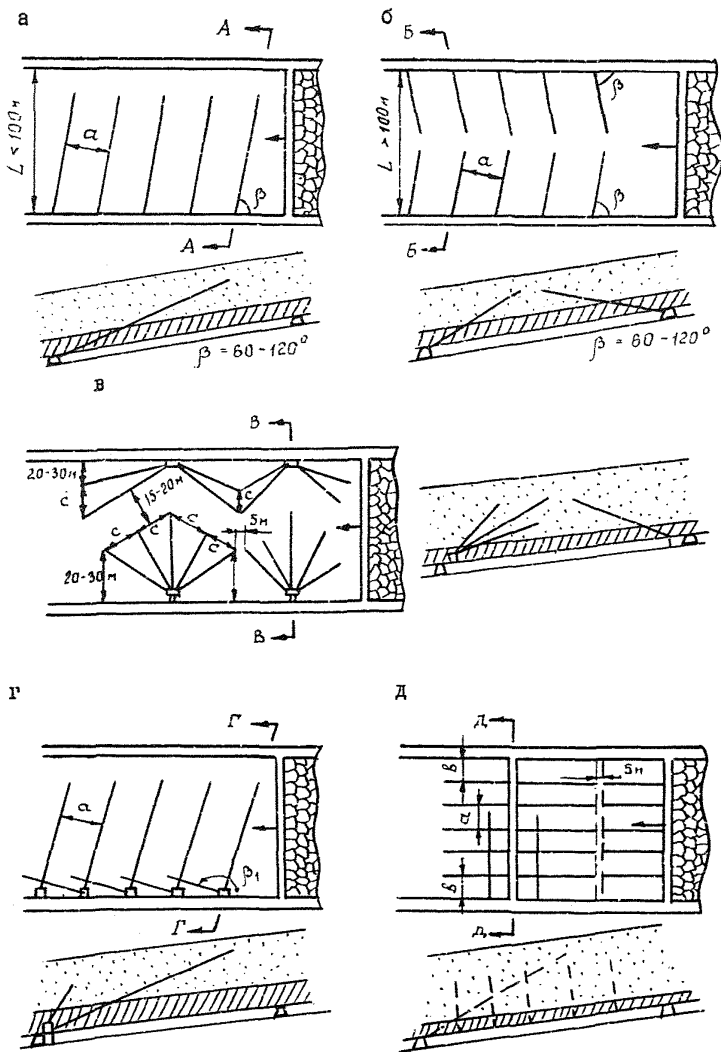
Схемы расположения скважин при вторичных посадках кровли
